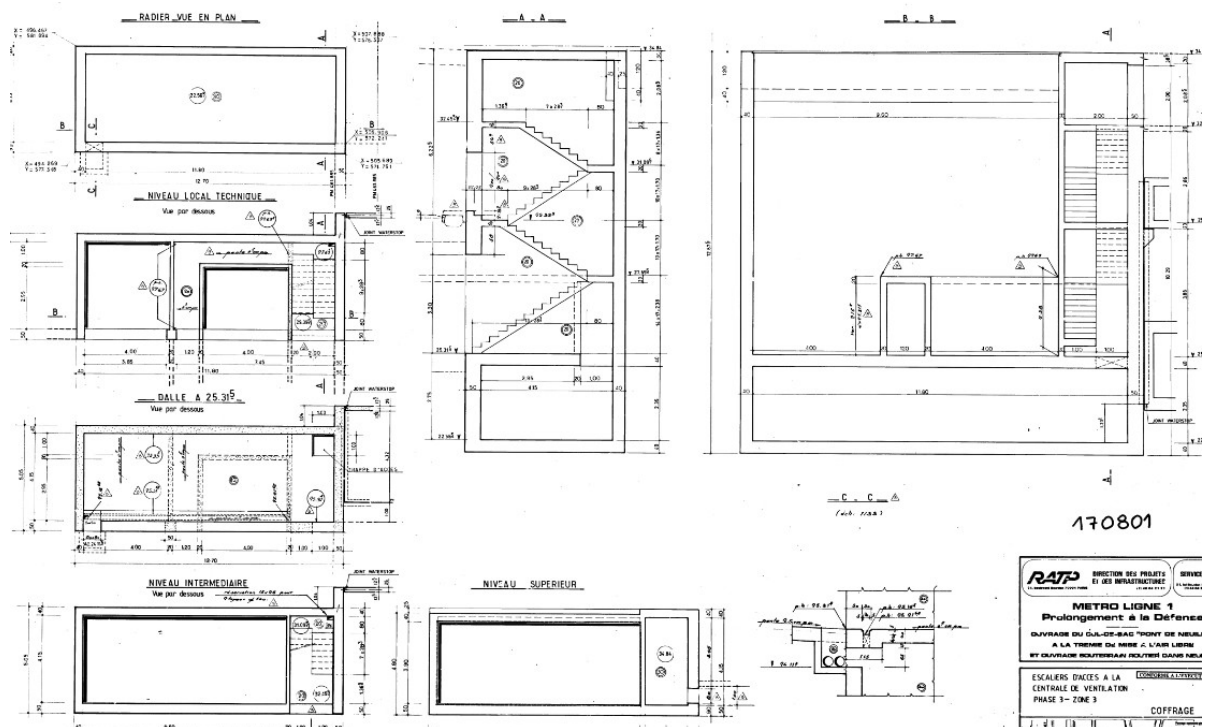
Escalier d'accès et puits de la centrale de ventilation\_plan 170801
